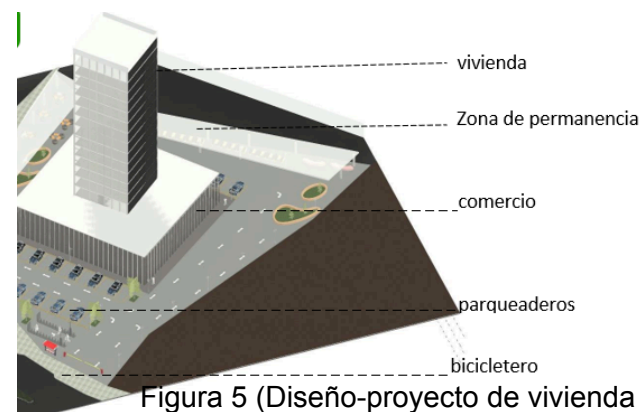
(Diseño-proyecto de vivienda Torre Aborigen)
